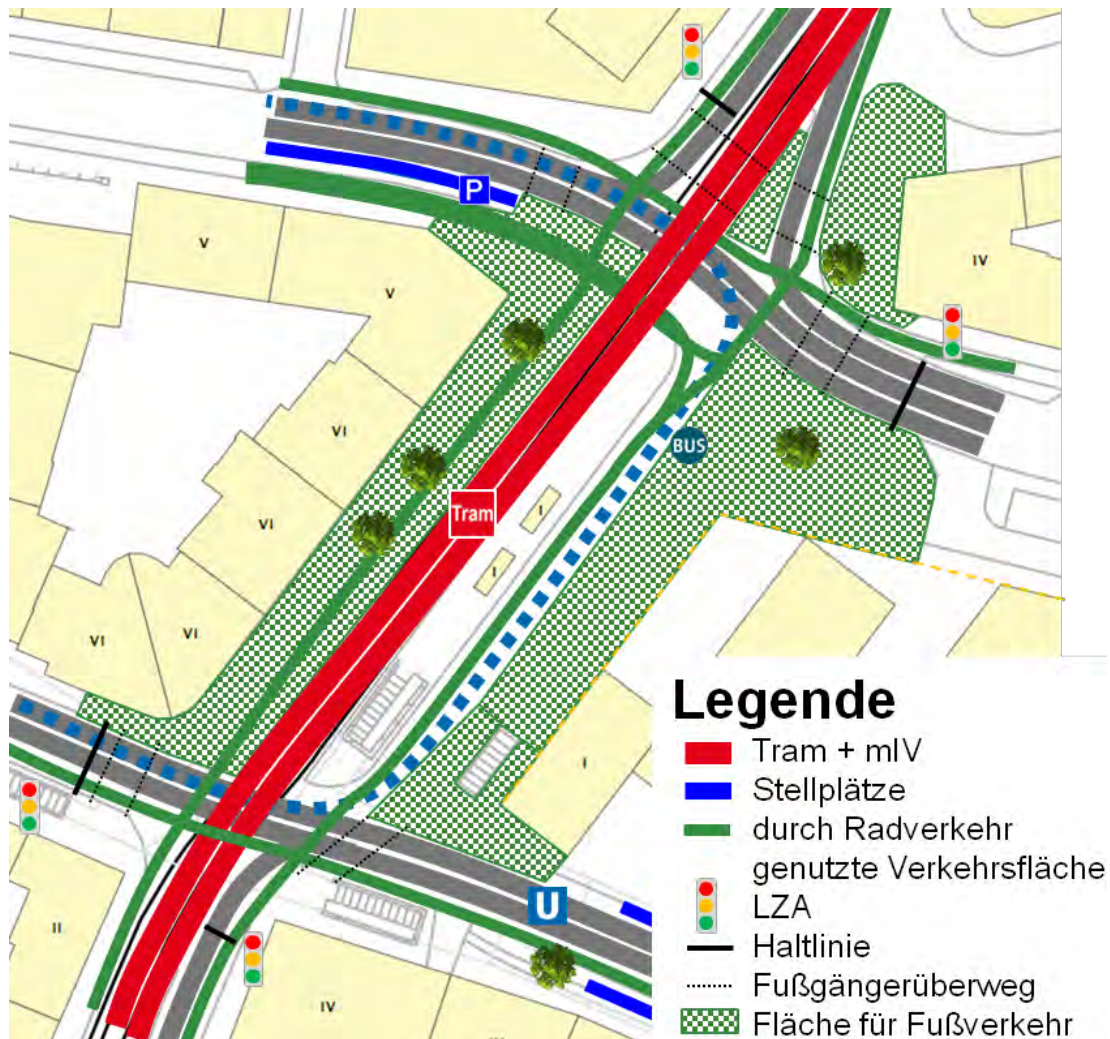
Lageplan des Tegernseer Platzes (Variante 1)
